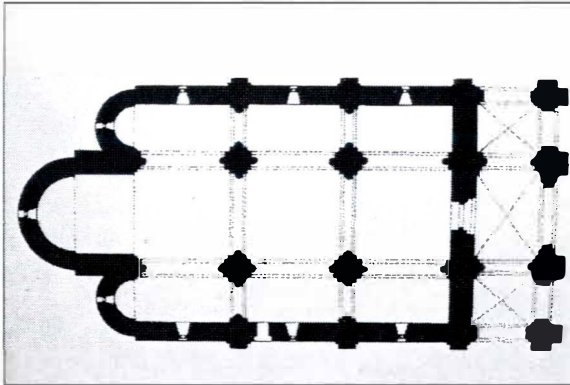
Planta de la Iglesia de Gerri de la Sal
